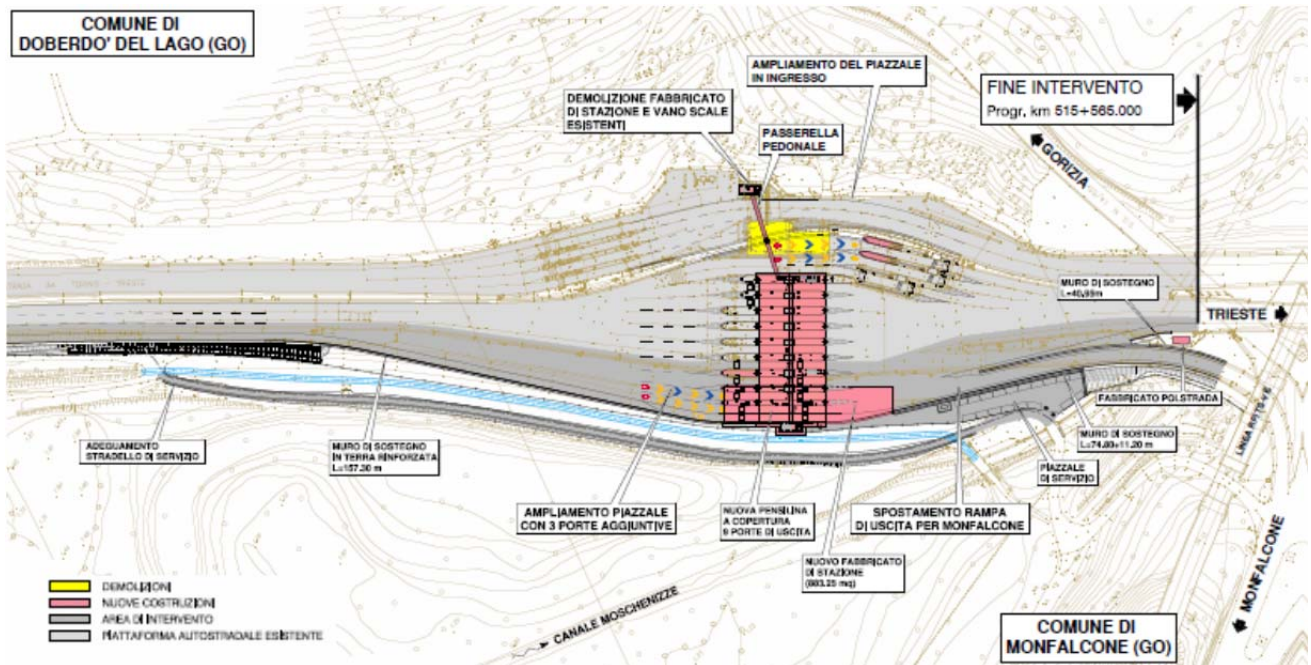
Estratto dell'elaborato A.04.00.0.0 "Planimetria generale".
